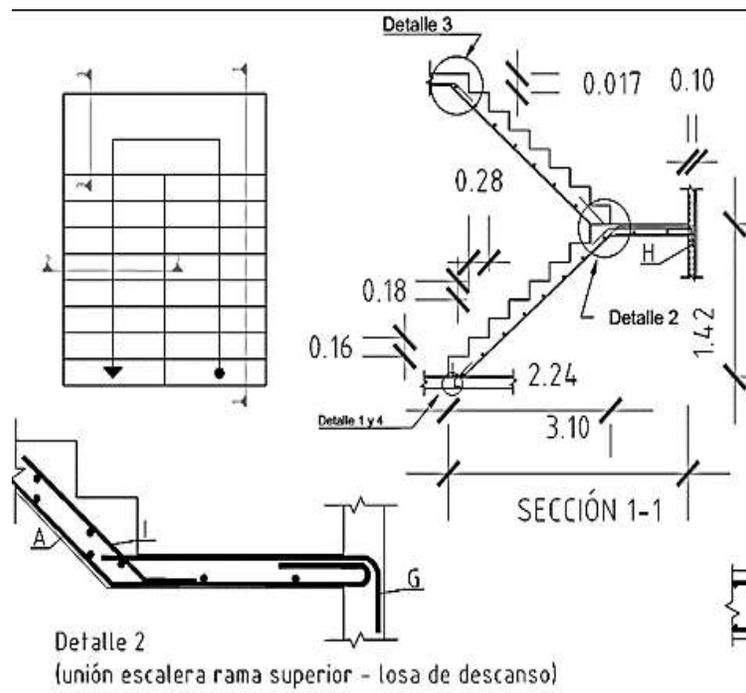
Ejemplos de sección y detalle de una vivienda
